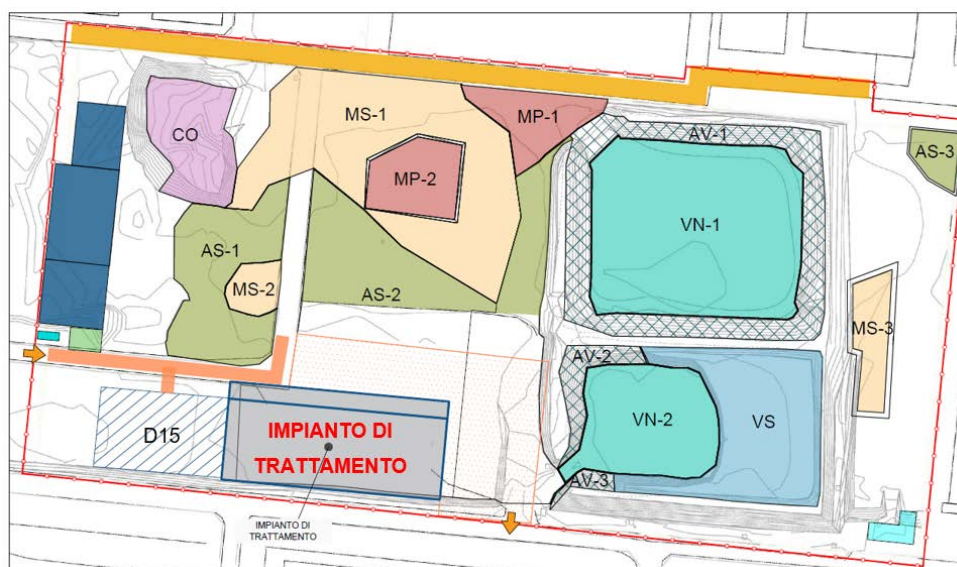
Planimetria area palte con individuazione delle zone di scavo, del deposito preliminare D15 e del capannone destinato ad ospitare l'impianto di trattamento
